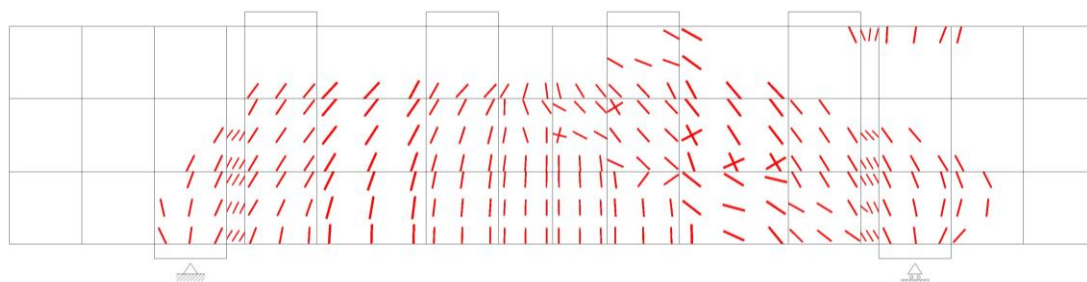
破壊時の変形及びひび割れ状態 (Case No. 11)
